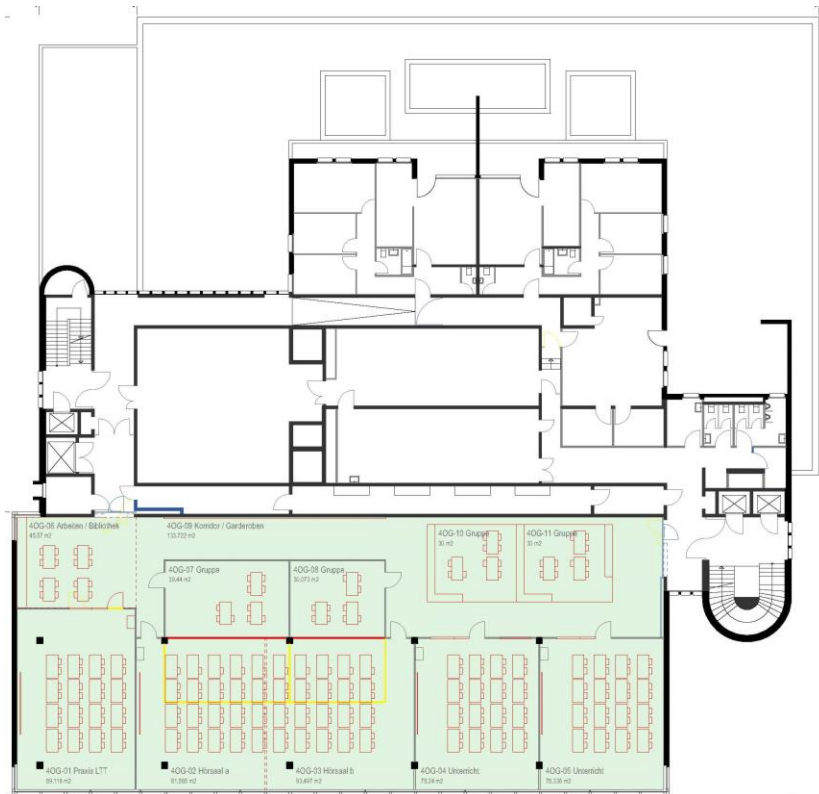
Grundriss Schule auf 2 Geschossen, 4. OG, Schulbereich
